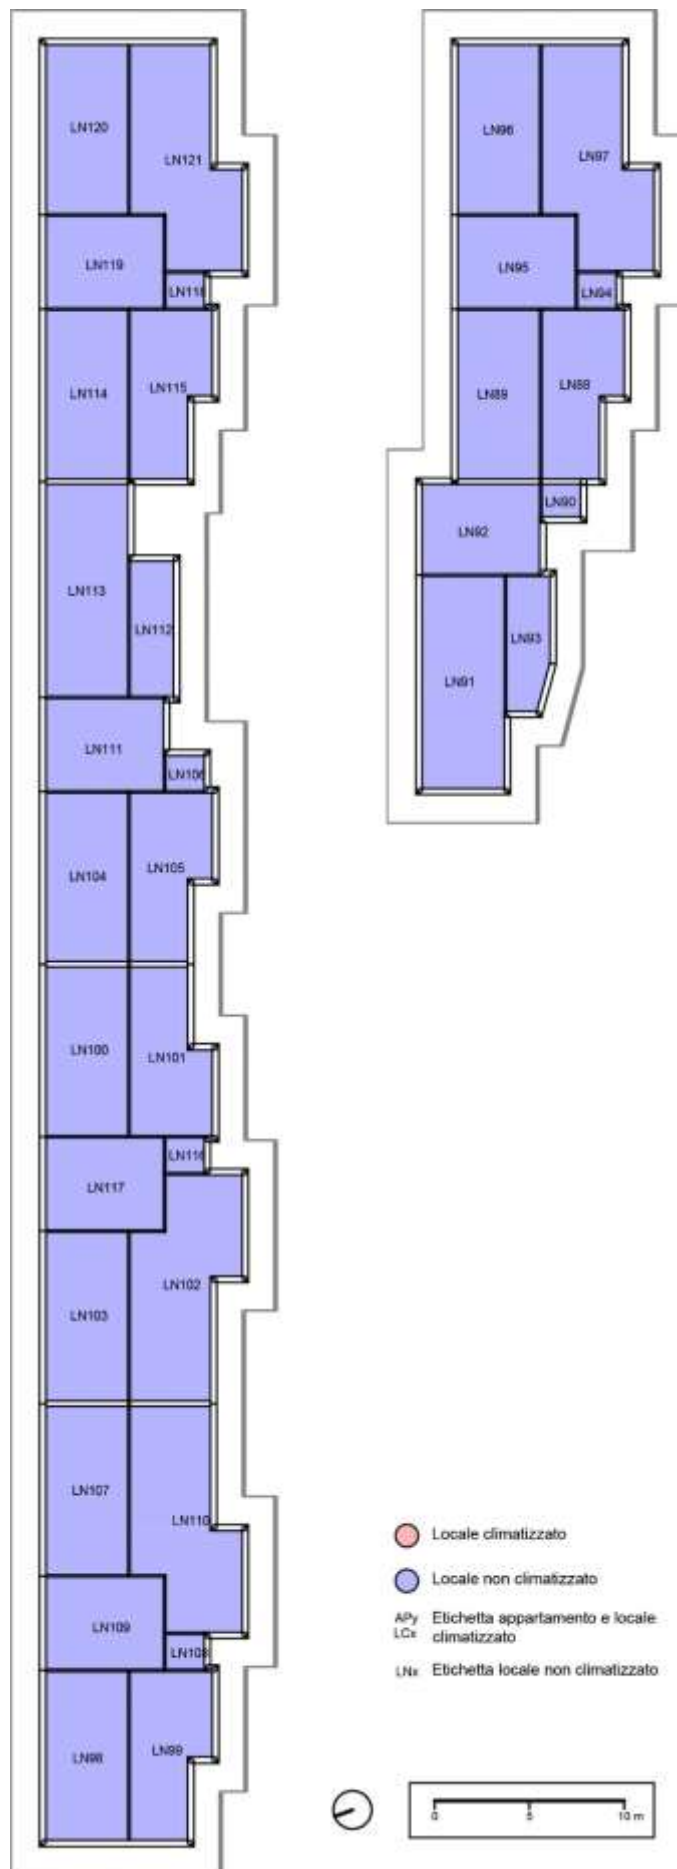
Pianta Sottotetto dei locali di Edilclima [Fonte: elaborazione dell'autore]
